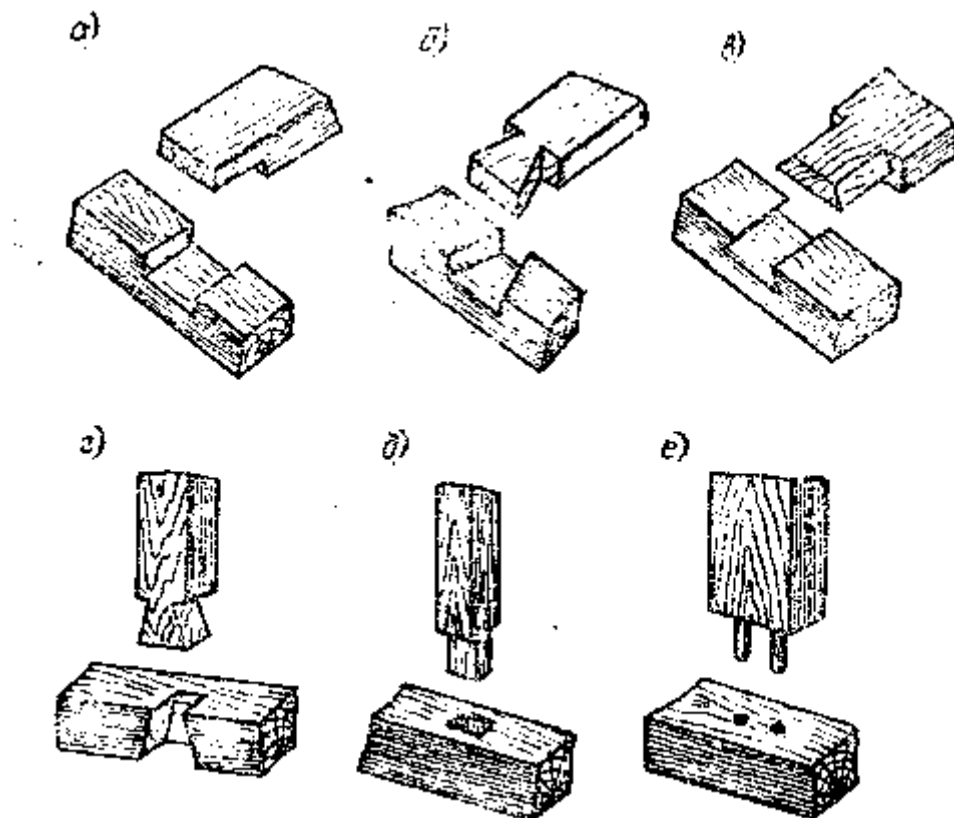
Тавровые вязки брусков: а — вполдерева; б — вполдерева «лапой»; в — трапецевидной накладкой; г — глухим сковороднем; д — прямым одинарным шипом; е — круглыми вставными шипами (нагельями)
